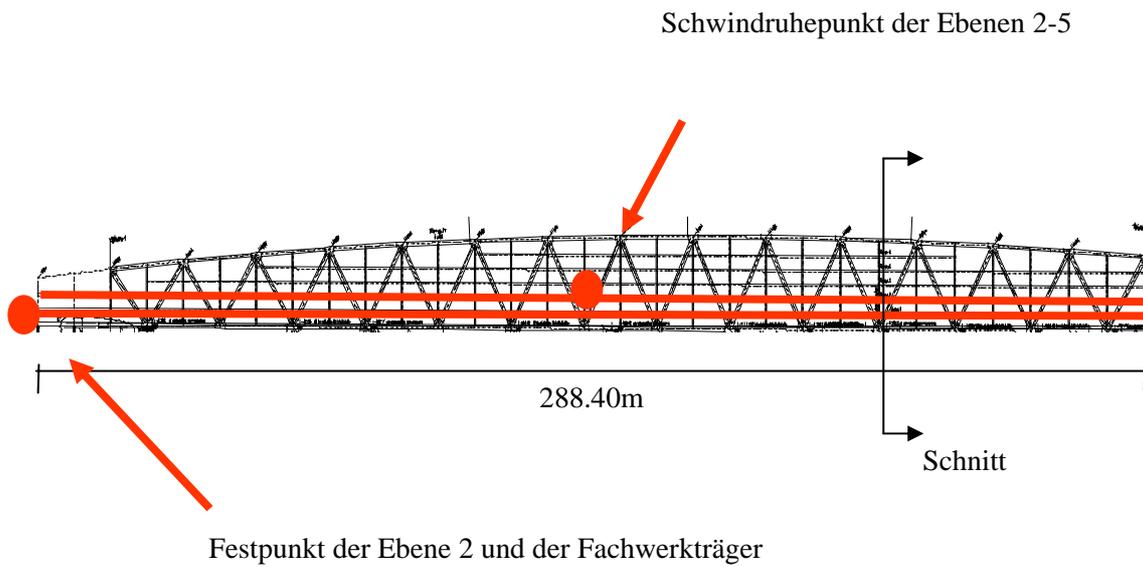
Schwindruhepunkte der verschiedenen Betondecken
